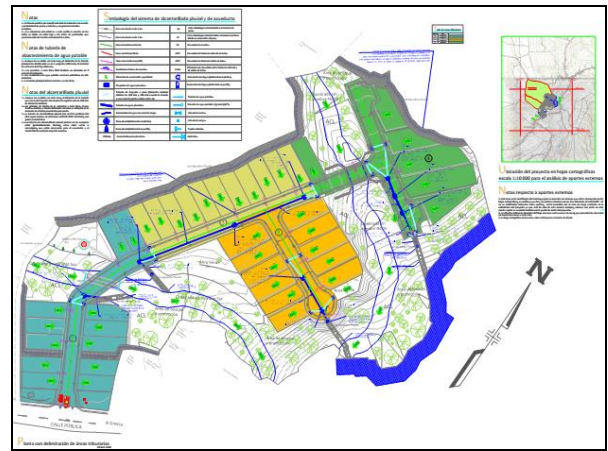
Planta de distribución del sistema de alcantarillado pluvial (Ver Apéndice, Lámina 8)
